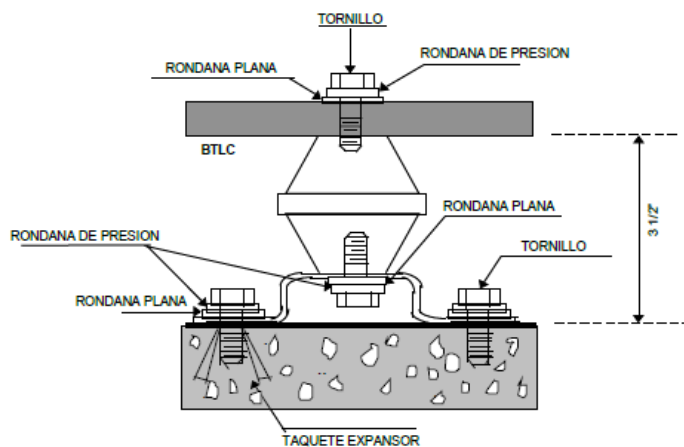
Tornillería para Fijar a Muros y Estructuras Metálicas.
